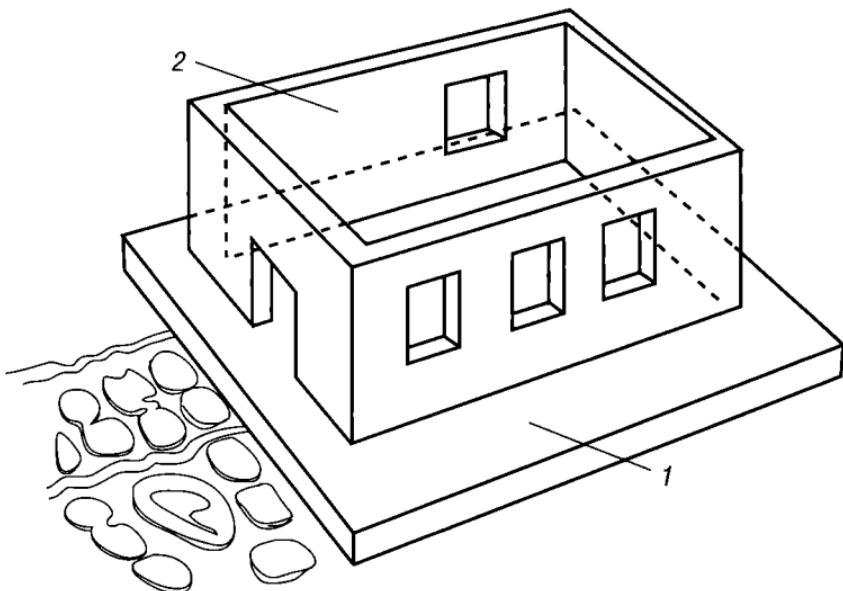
Размещение дома на цельной бетонной незаглубленной плате:
